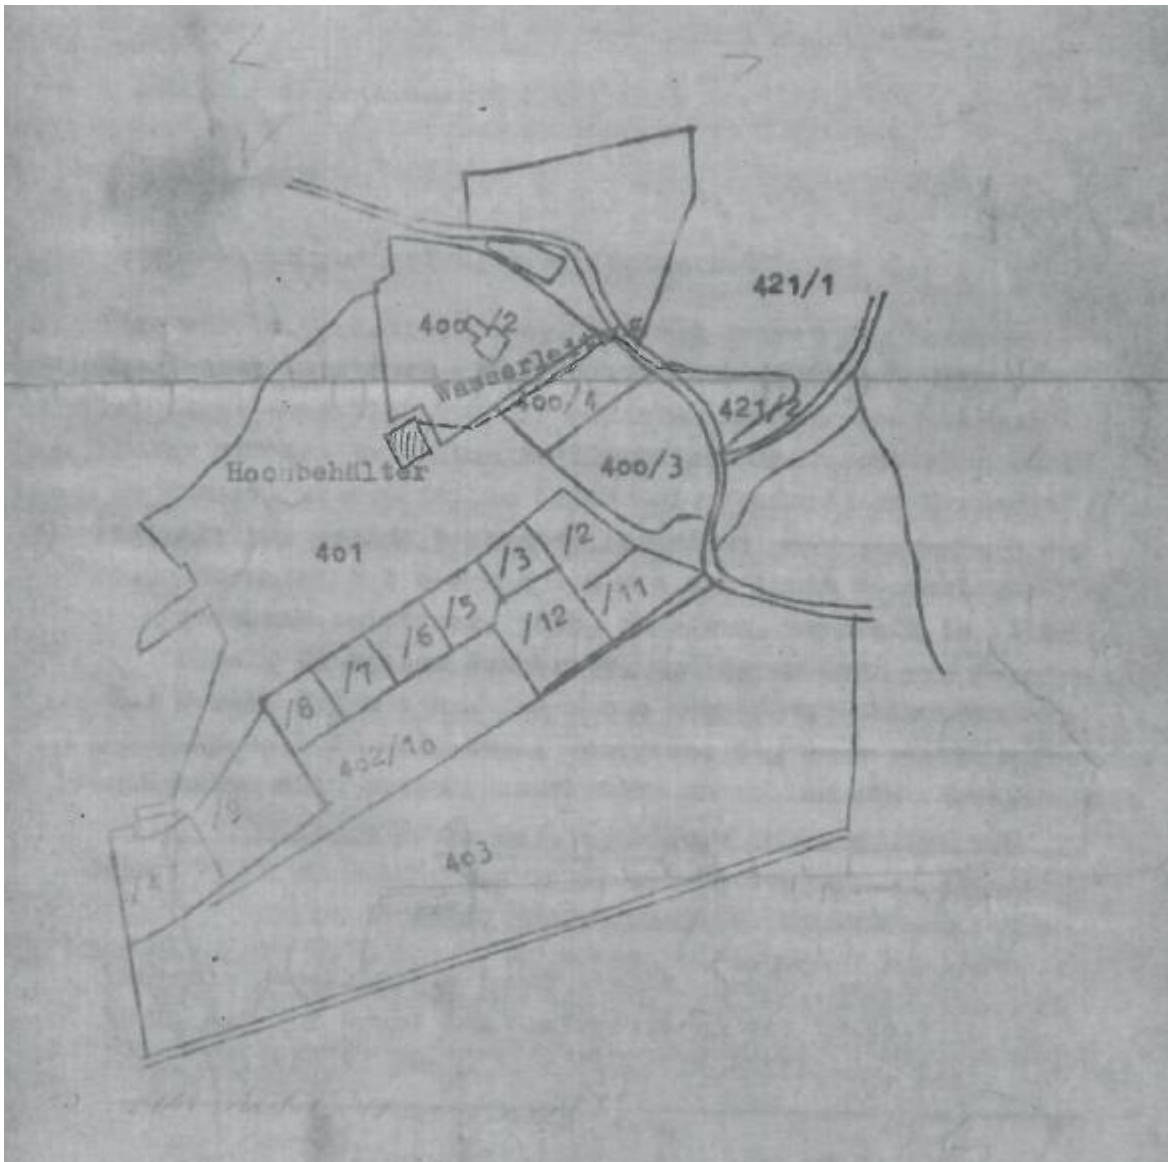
Historischer Lageplan der Trinkwasserleitung (Dienstbarkeitsvertrag 05.10.1966)
